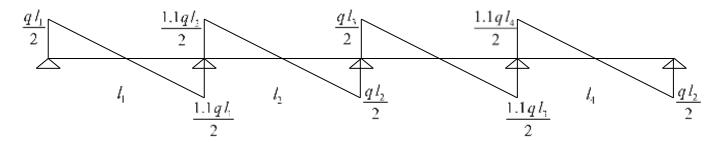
Evaluation des efforts tranchants d'une poutre a plus deux travées
